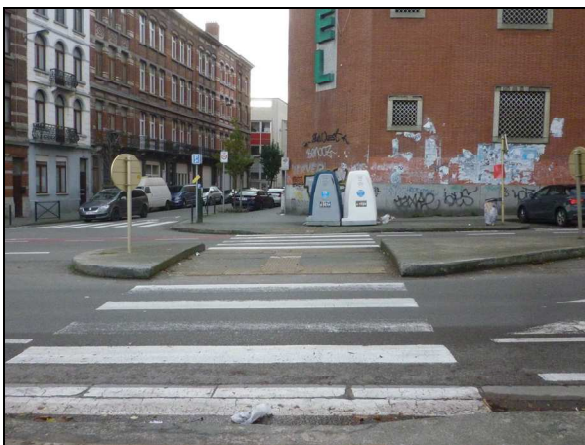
Vue de la traversée piétonne aménagée (dalles podotactiles) rue Picard, au droit du site
